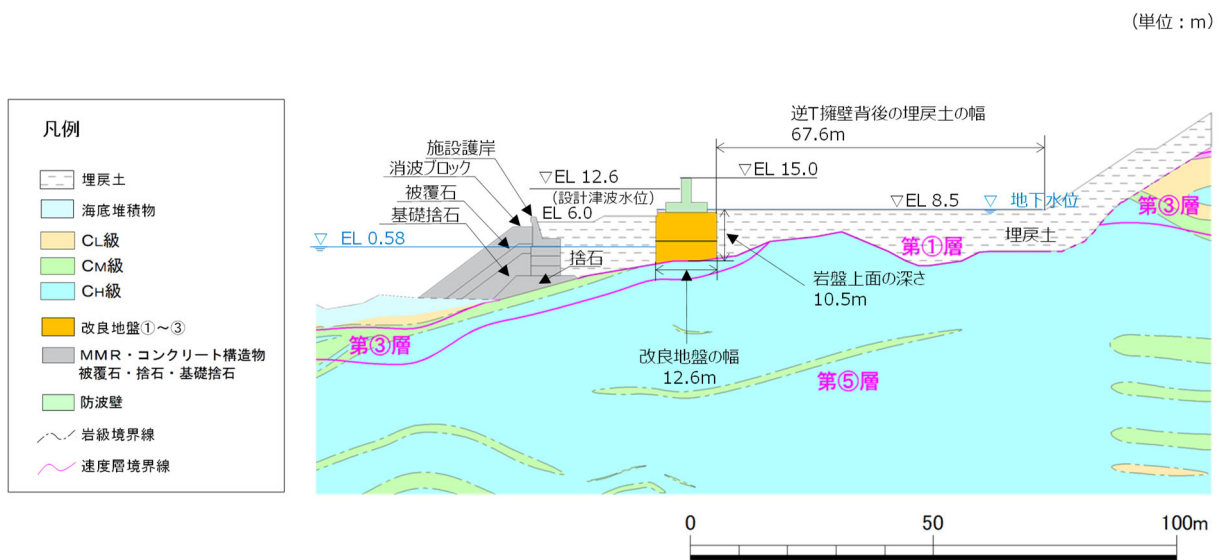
防波壁（逆T擁壁）の横断面図（②-②断面）
